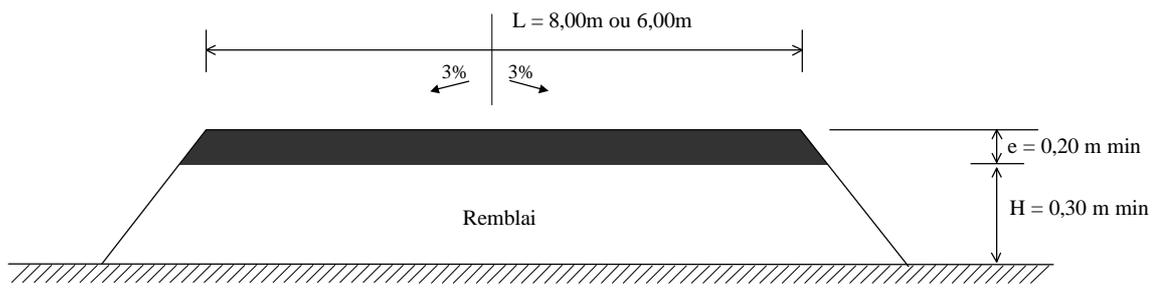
Profil en travers type de pistes sur les sols dans les plaines
